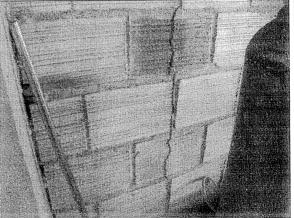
Agrietamiento vertical en la zona inferior del panel de muro.
